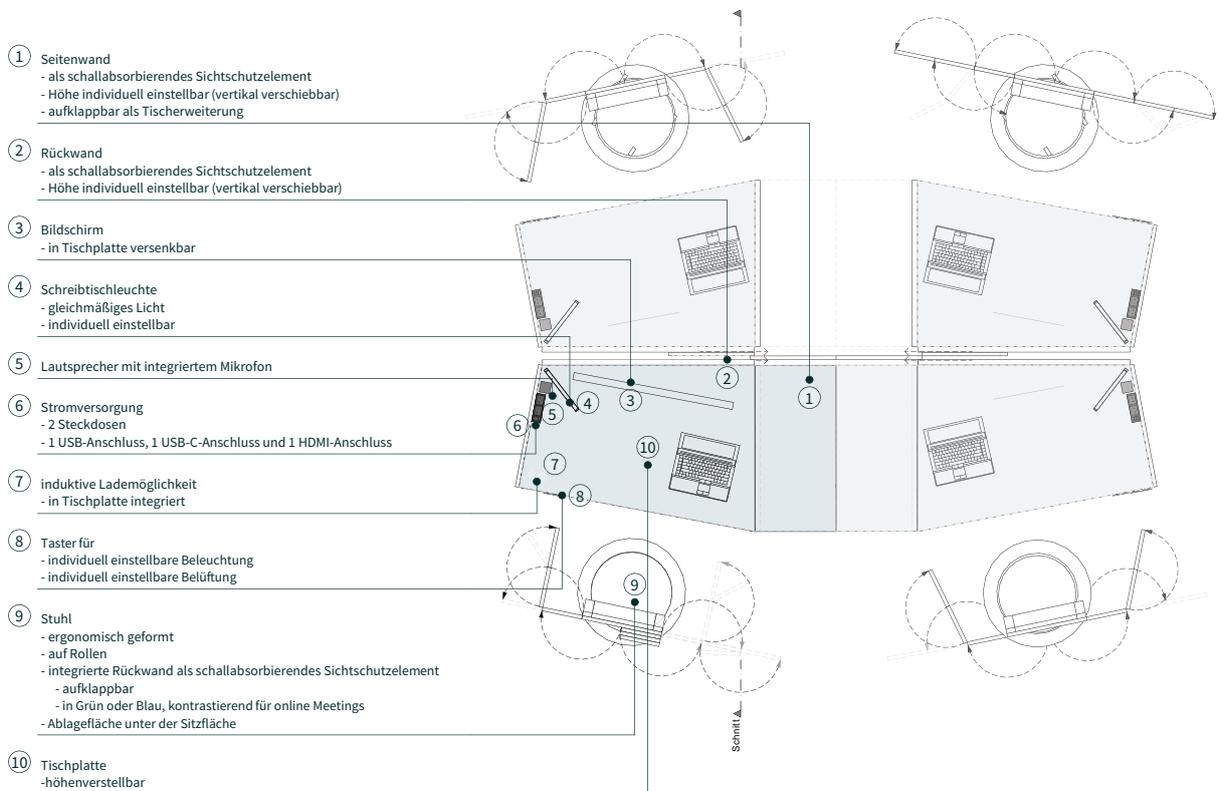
Grundriss des *Public-Office
